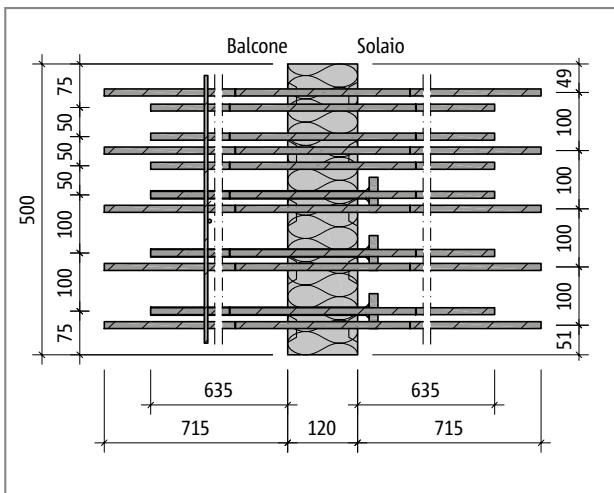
Schöck Isokorb® tipo EXT50-L-V12: pianta del prodotto
